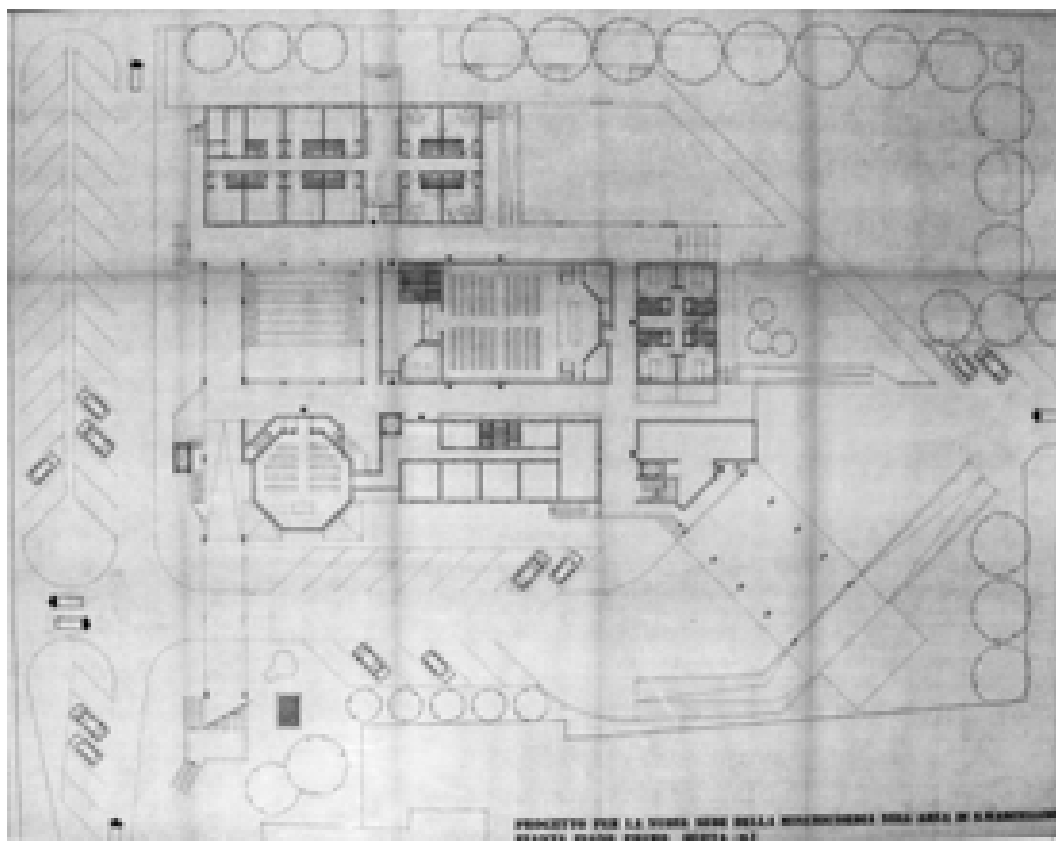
Planimetria, stato futuro – 1989 (AABS-64_607)
